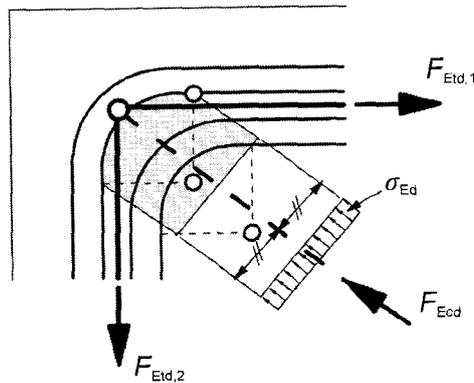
Druck-Zug-Knoten mit Bewehrung in zwei Richtungen
